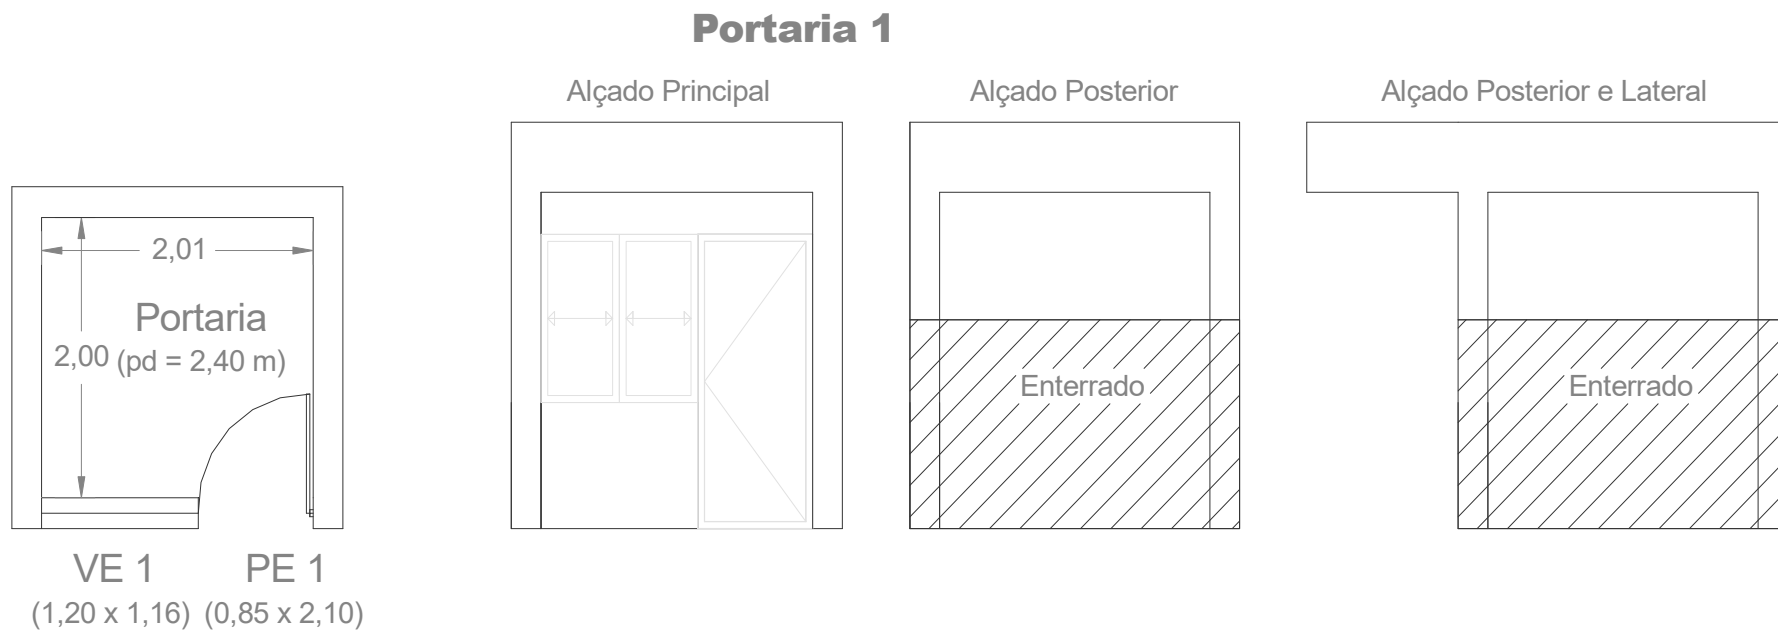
Desenho 2D do levantamento dimensional e geométrico da Portaria 1.
